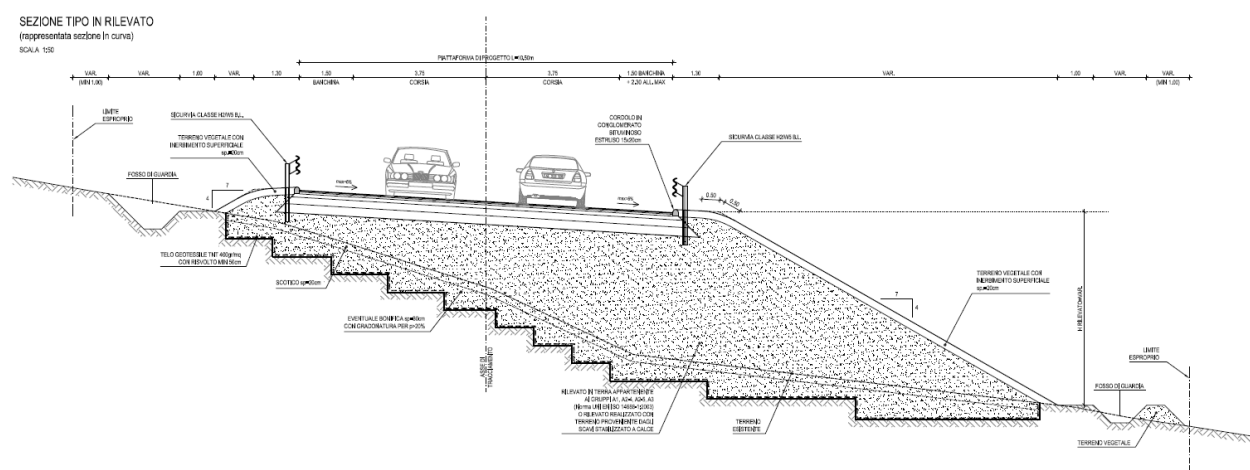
Esempio di sezione trasversale tipica dell'asta principale
